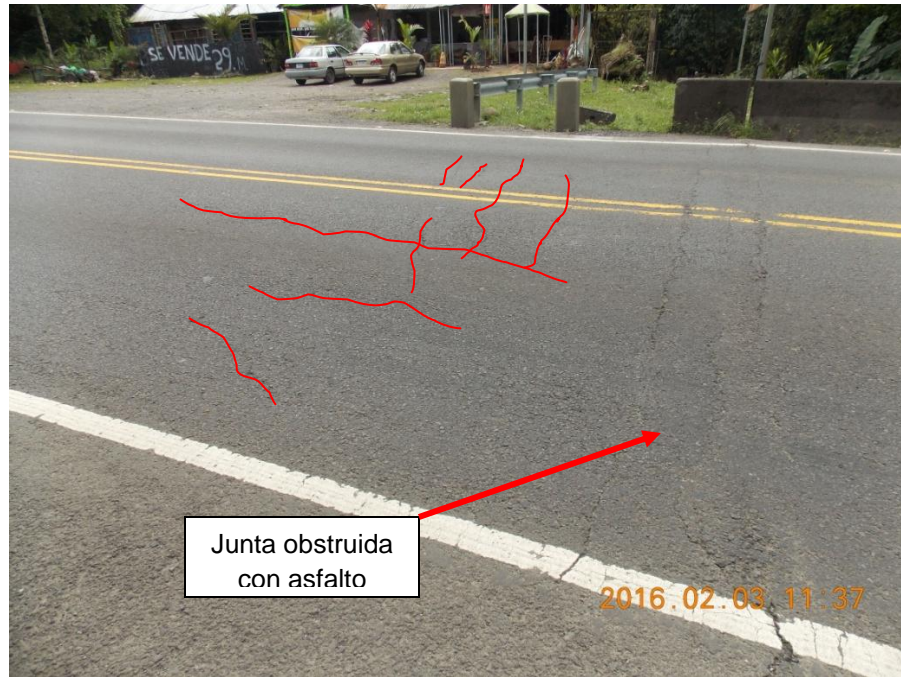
Junta de expansión sobre bastión 1 cubierta por asfalto y grietas en carpeta asfáltica de acceso 1.
